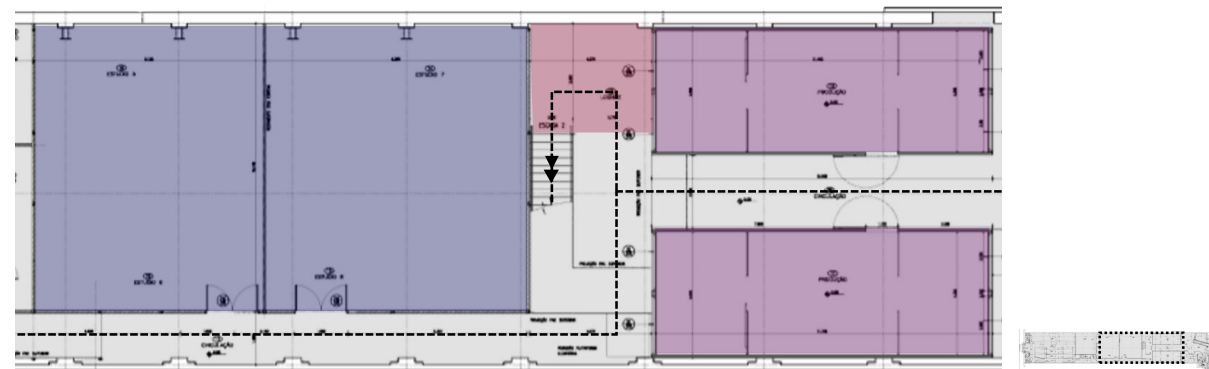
Planta baixa do térreo e andar mezanino seccionadas.
